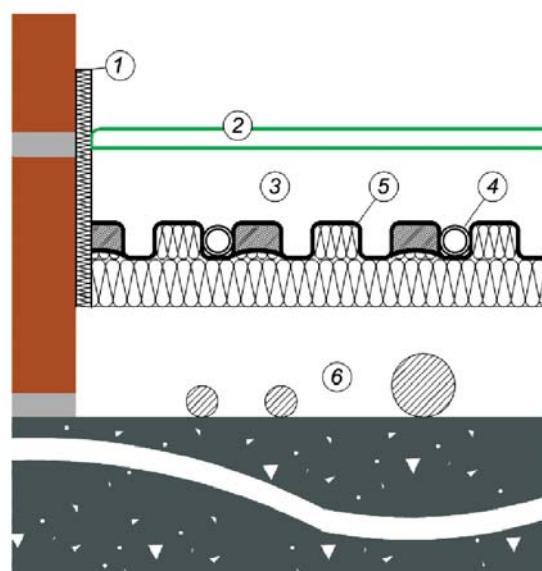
Конструкция теплого пола: 1 – демпферная лента; 2 – напольное покрытие; 3 – стяжка; 4 – труба теплого пола; 5 – профильный мат; 6 – бетонная плита
